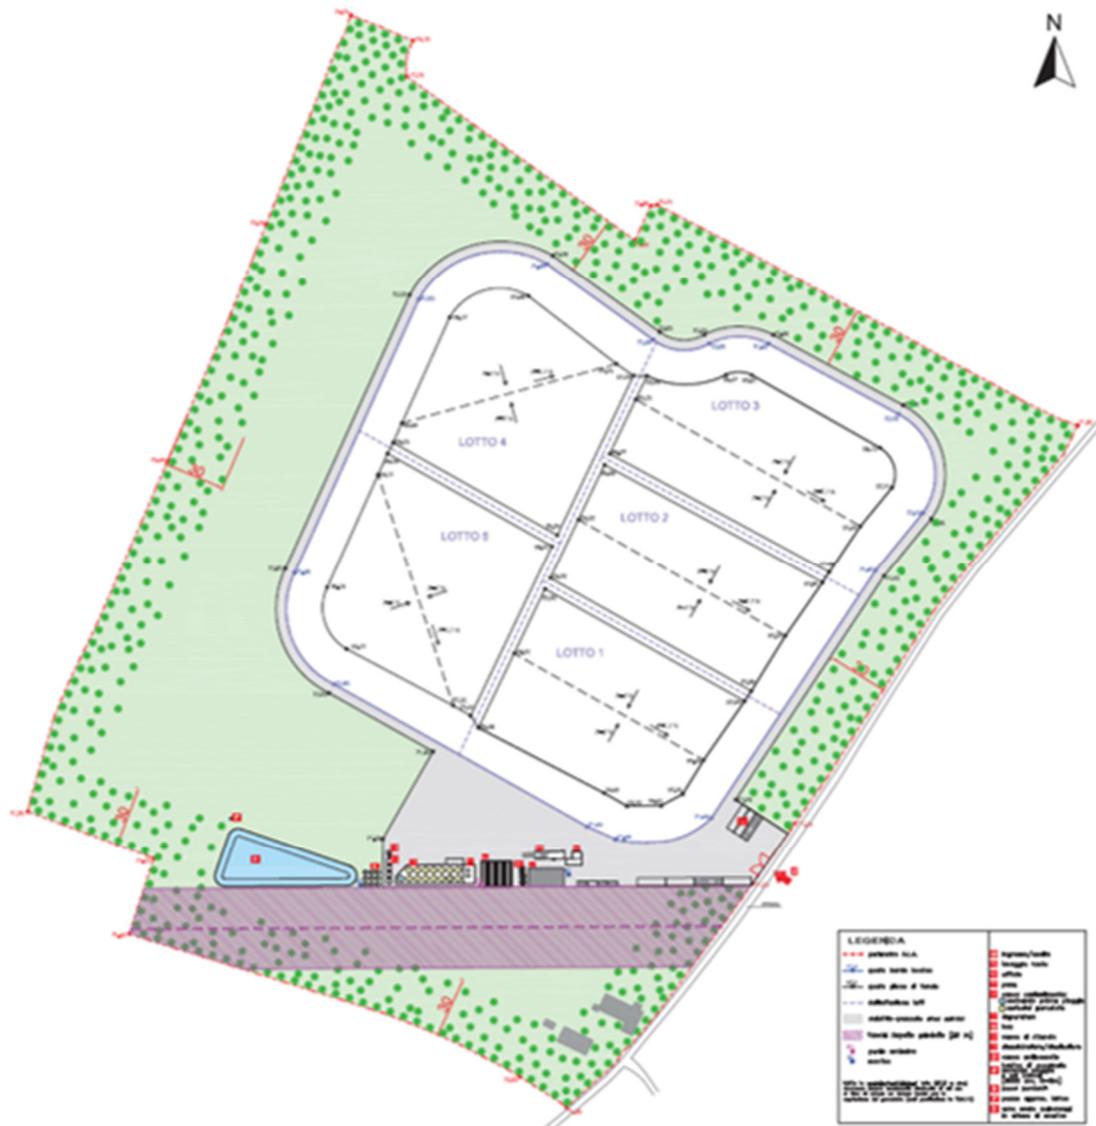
Planimetria generale di progetto (Estratto Tav. 02).
